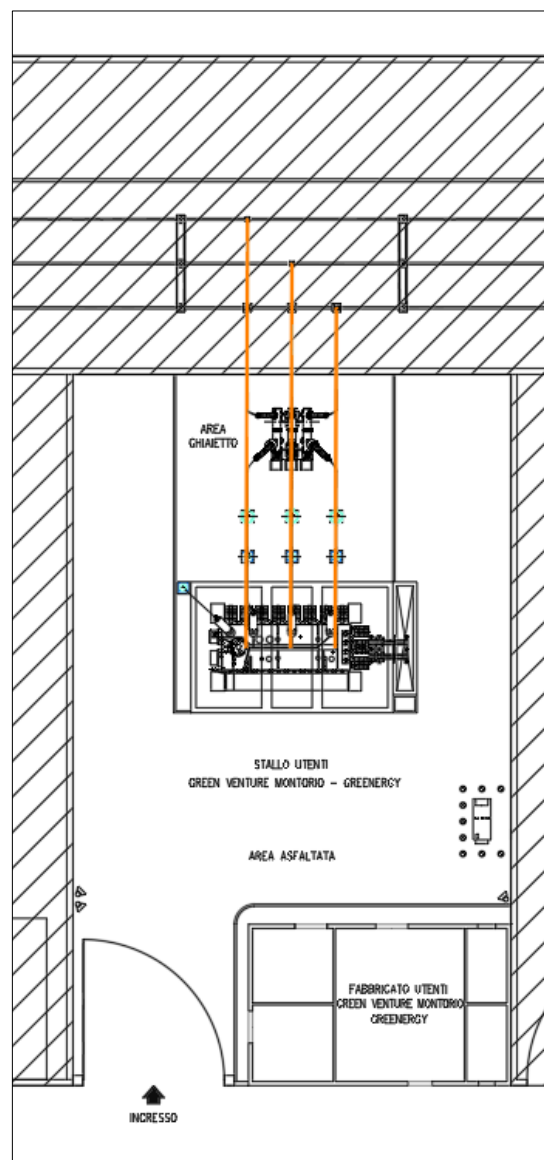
Planimetria della cabina utente con individuazione degli elementi attivi
